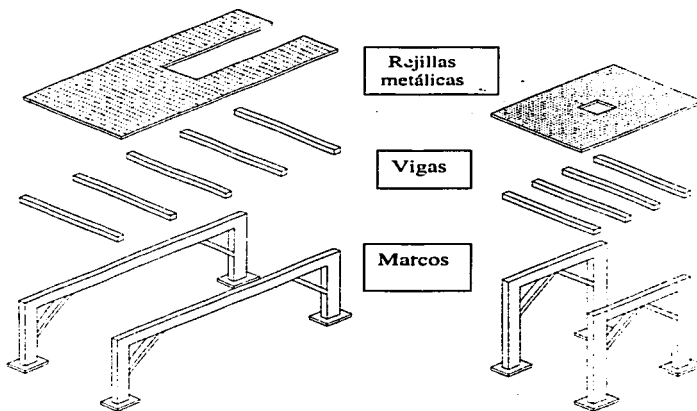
Elementos que conforman las estructuras ilustradas.
